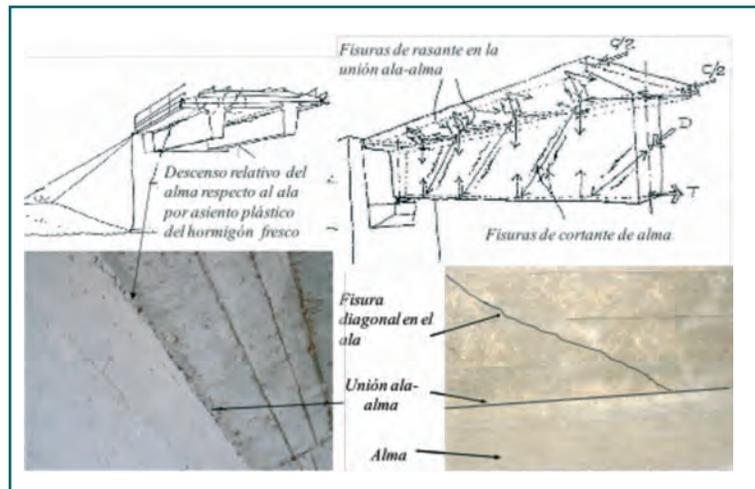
Diferencia entre fisura de rasante y de asiento plástico del hormigón en la unión ala-alma.
